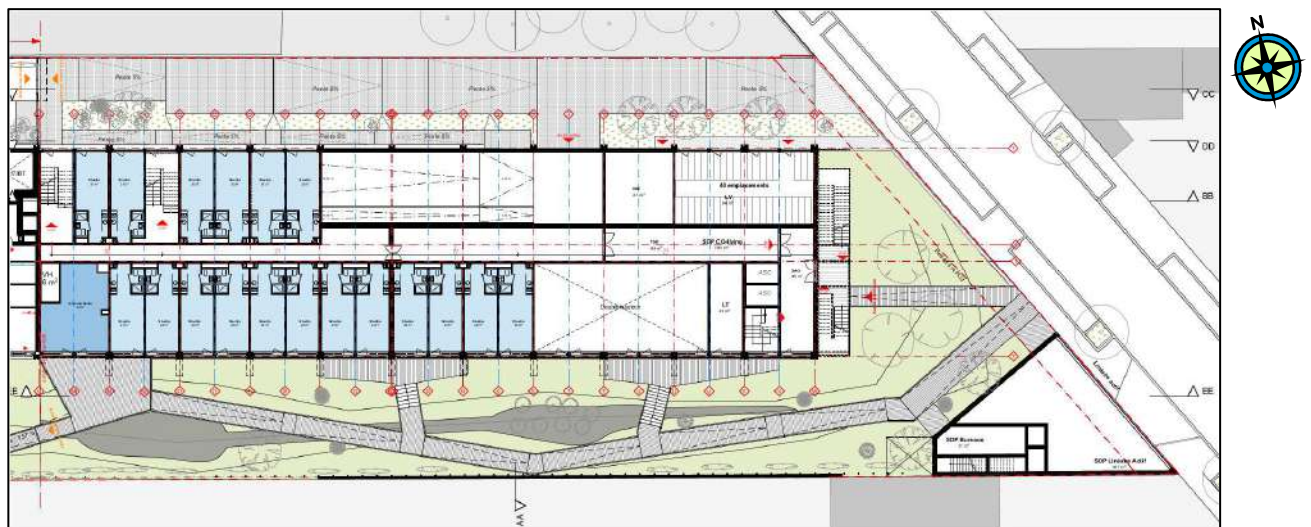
Plan du R+1 du projet – lot 2 (BRENAC & GONZALEZ Architectes)
